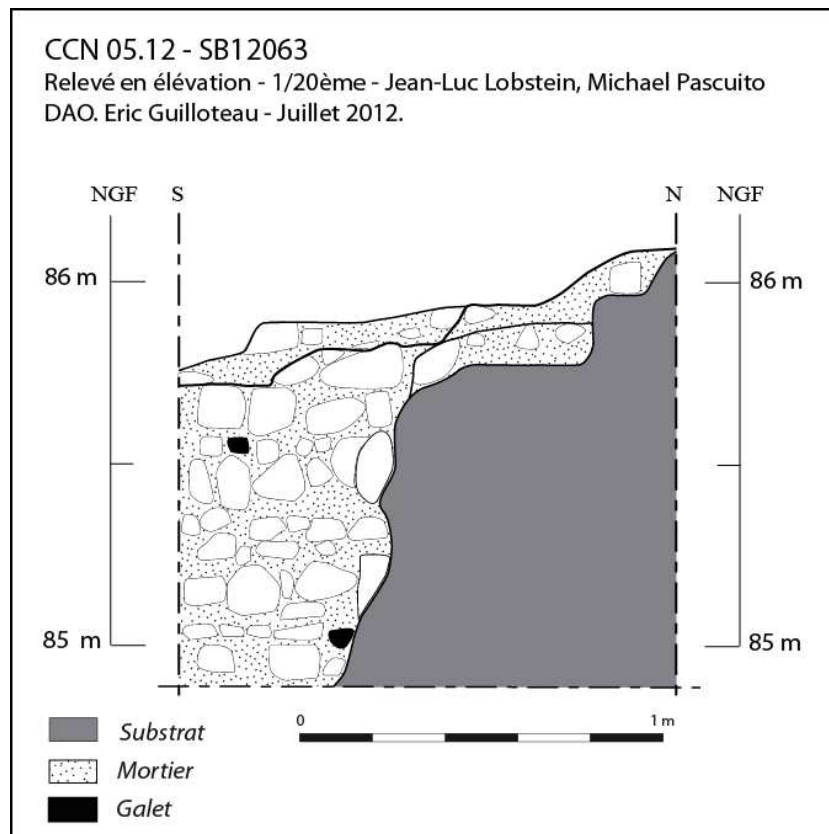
Relevé en élévation de la structure SB 12063 (DAO. E. Guilloteau/SAVN).
